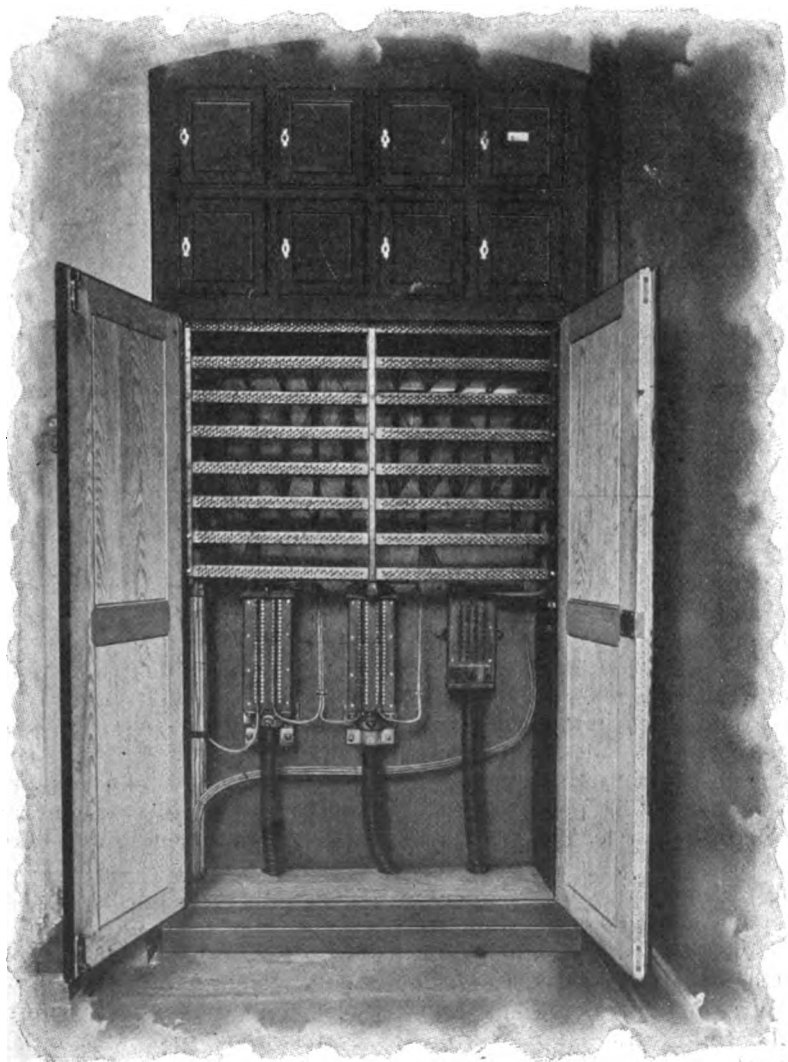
Hauptverteiler mit Kabelendanschlüssen.
